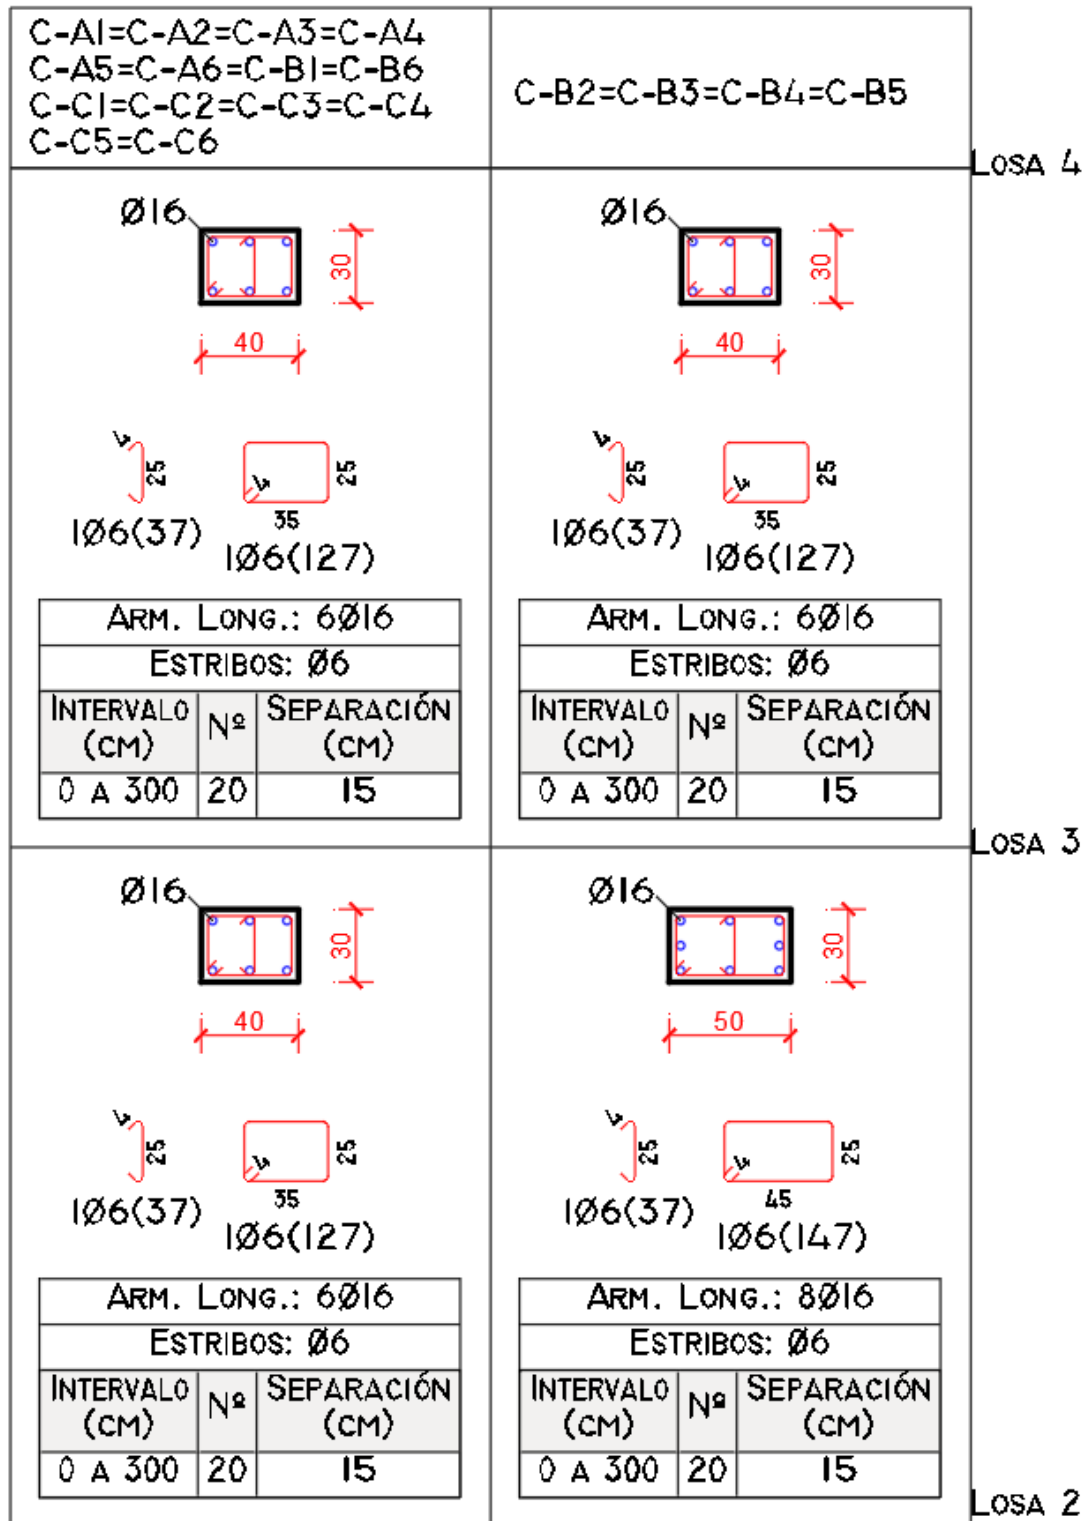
Detalle de Refuerzo Columnas, de Losa 2 a Losa 4, Estructura [7N-SS].
